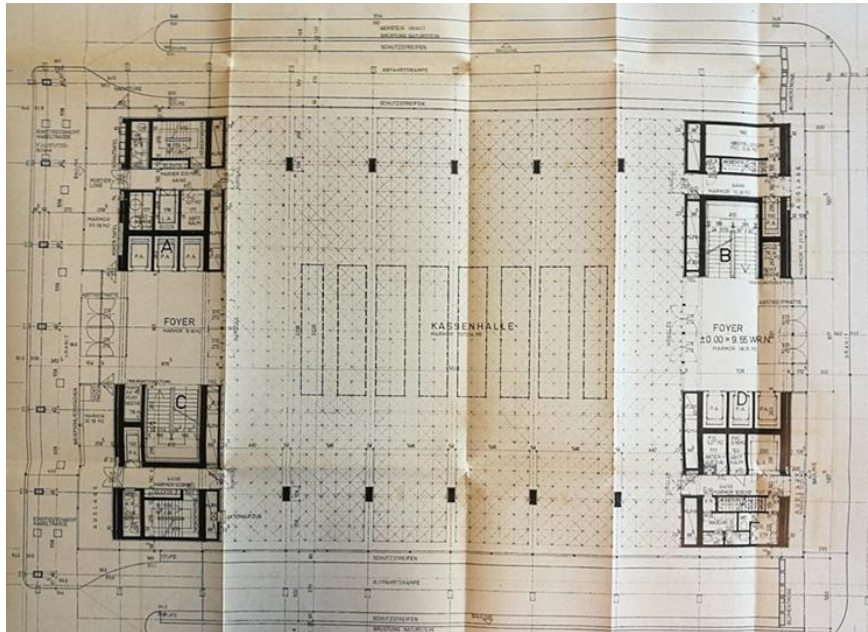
Grundriss Erdgeschoß, Ausführungsplan, Hauptanstalt Wien 3, Artur Perotti, 1965
